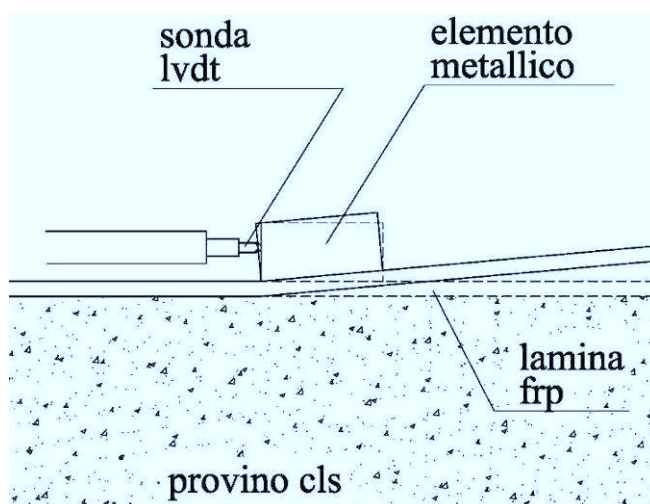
Propagazione del meccanismo di delaminazione con innalzamento della lamina
